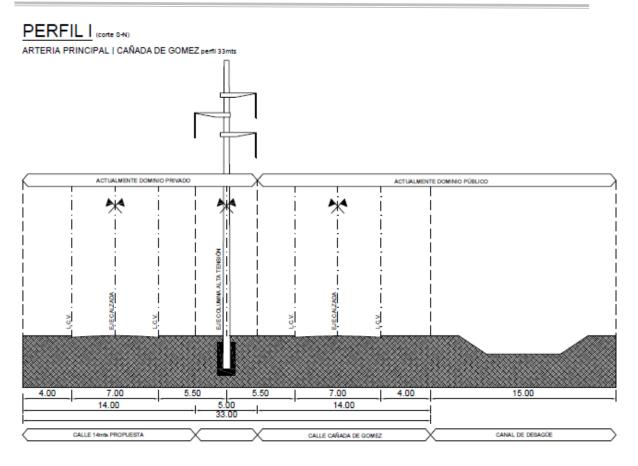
Perfil propuesto para la calle Cañada de Gómez. (Fuente: EDISUR S.A.)
